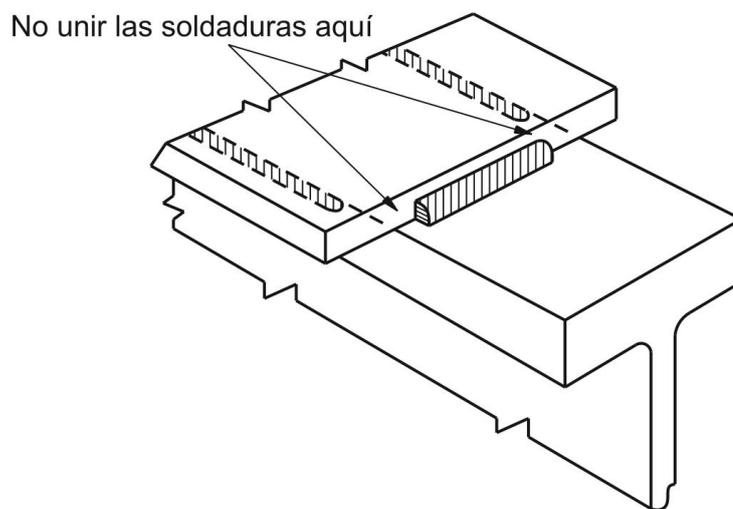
Soldaduras de filete en los lados opuestos sobre un plano en común.
